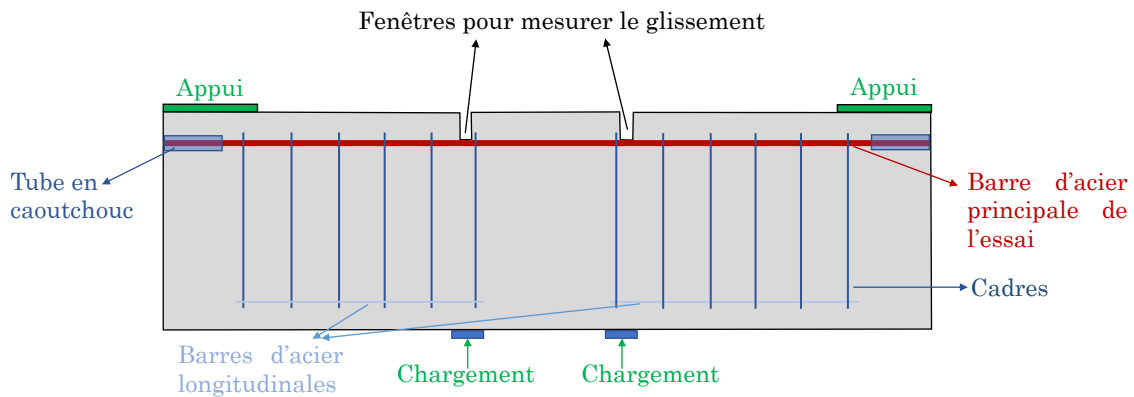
Essai proposé par [ACI Committee 408, 1964] sur une poutre.
